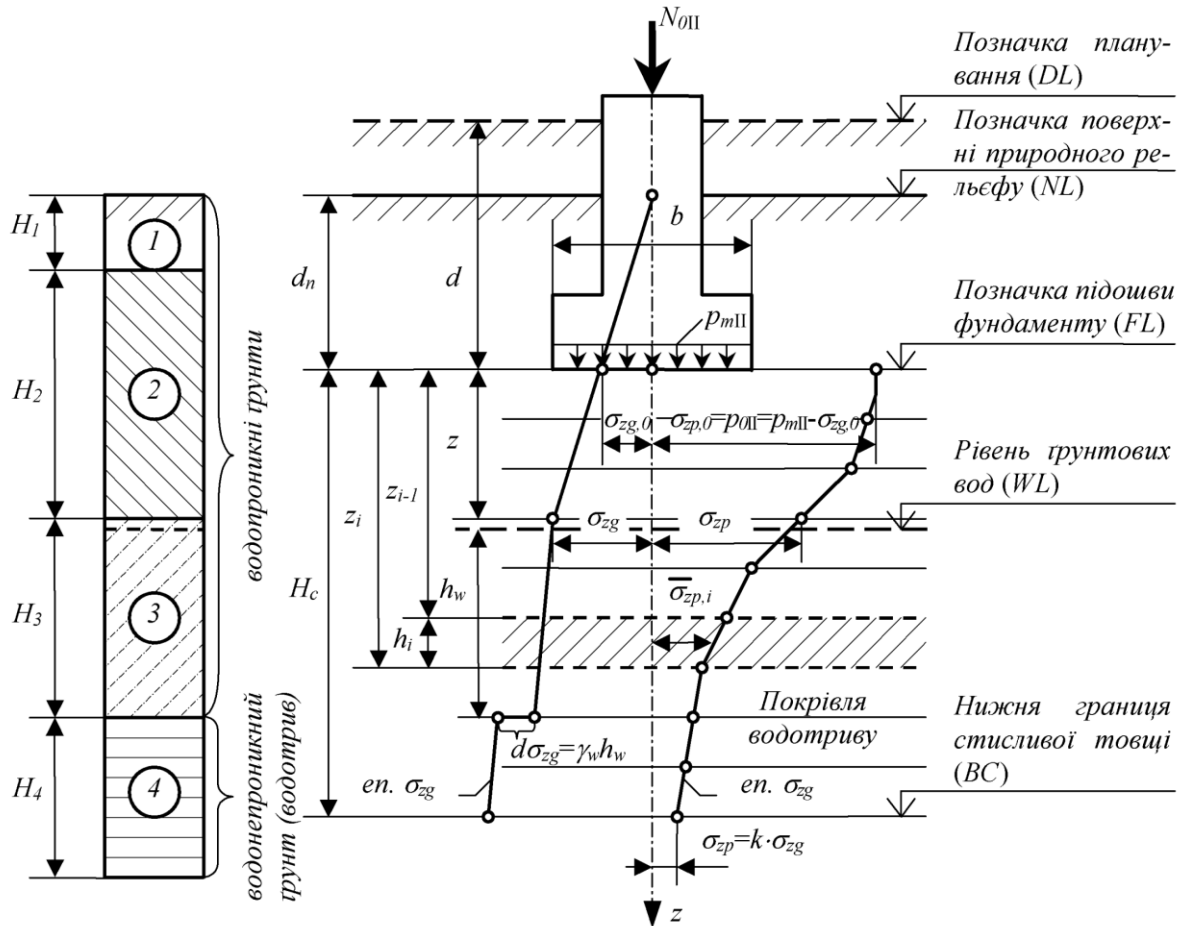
Схема розподілу вертикальних нормальних стискаючих напружень в основі при розрахунку сумісних осідань основ і фундаментів методом пошарового підсумовування
